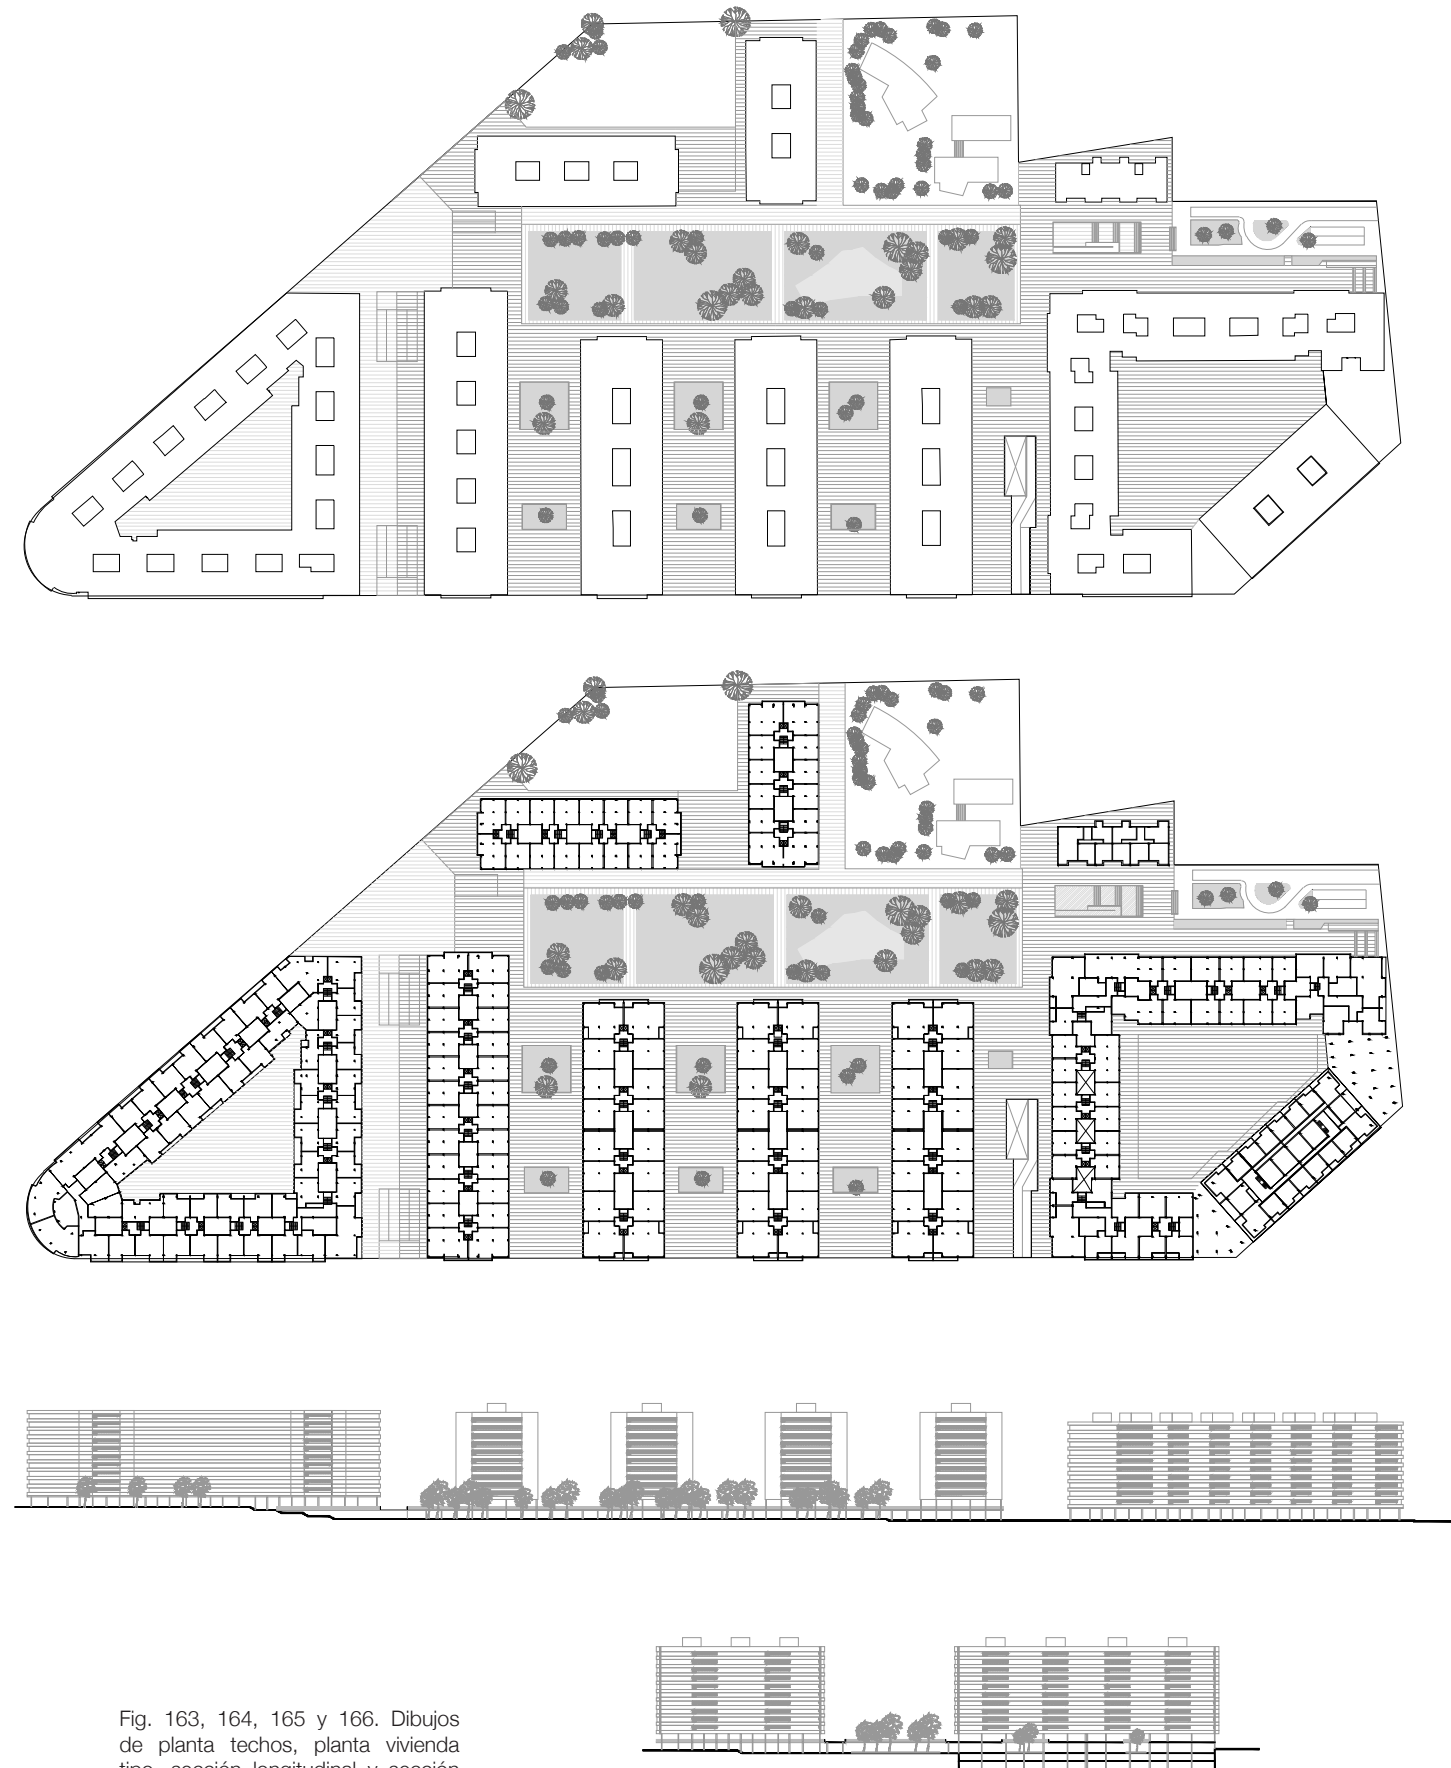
, 164, 165 y 166. Dibujos de planta techos, planta vivienda tipo, sección longitudinal y sección transversal de Urb. Parque Roma. E. 1:2500
